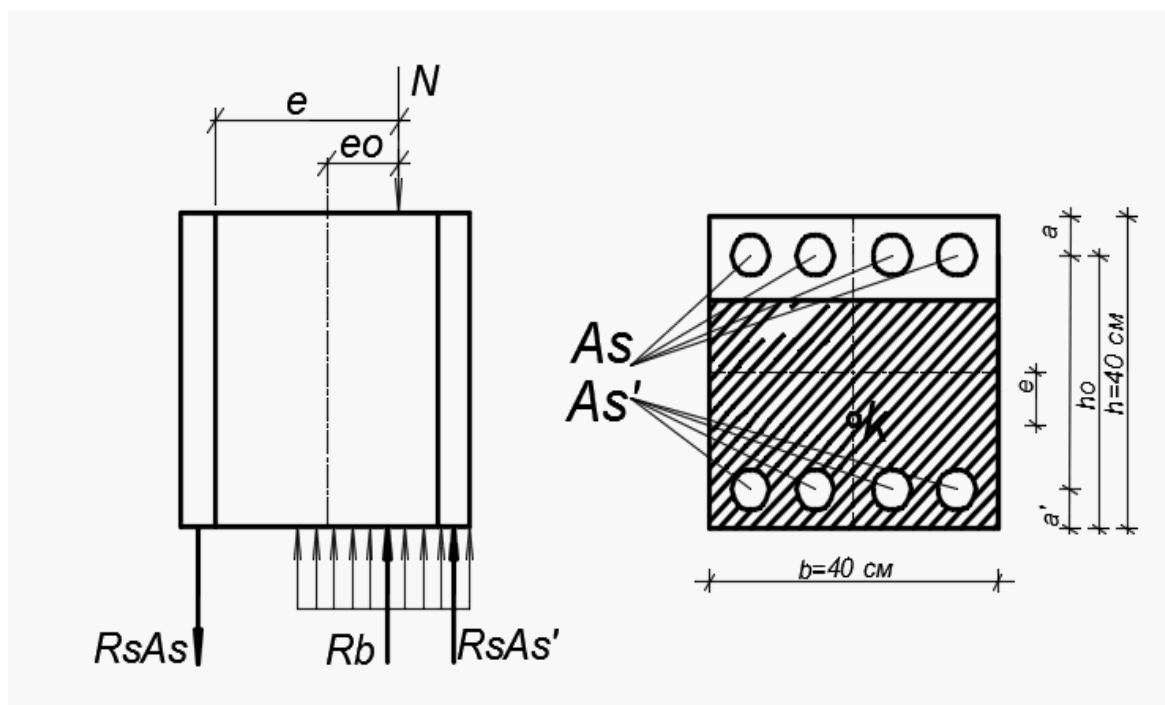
Предельное состояние внецентренно сжатой колонны, армированной двойной стержневой арматурой
